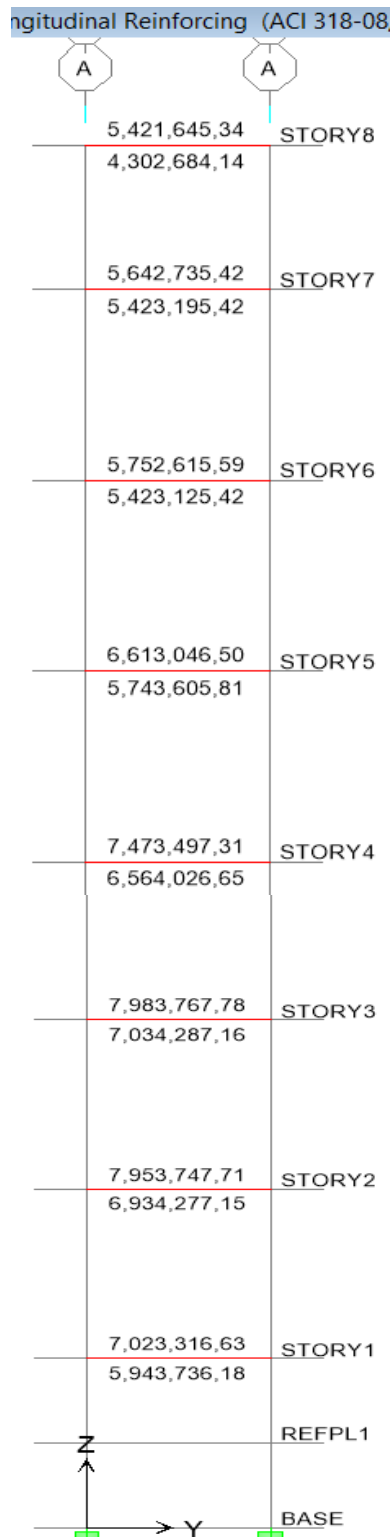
Acero en Vigas y Columnas en el Pórtico A – Escaleras de Emergencia Hospitalización 2- (NEC-11)
